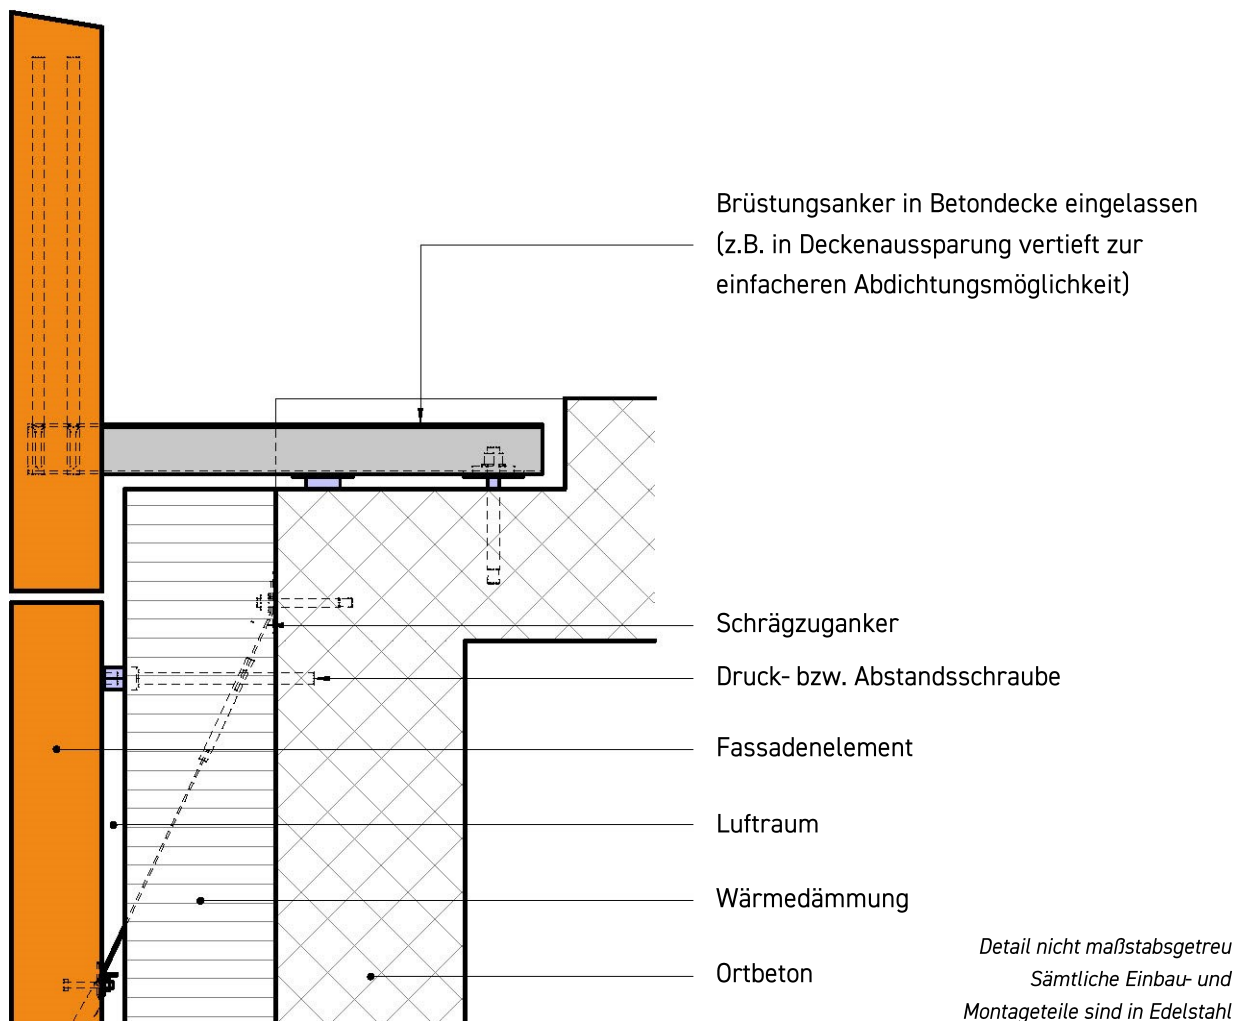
BRÜSTUNGSANKER EINGELASSEN
